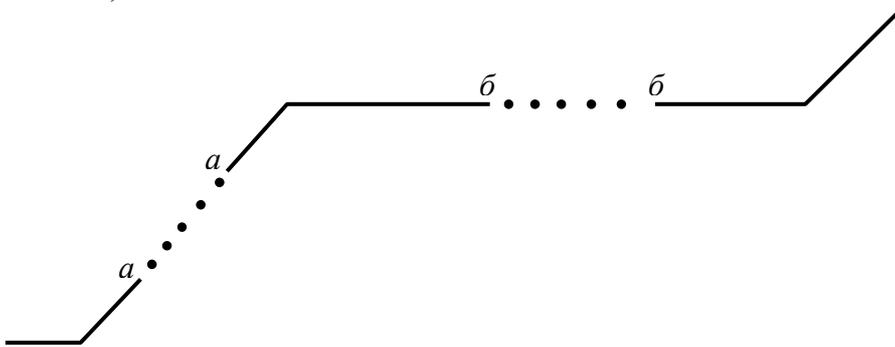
Изображение разрывов воздухопроводов и трубопроводов
